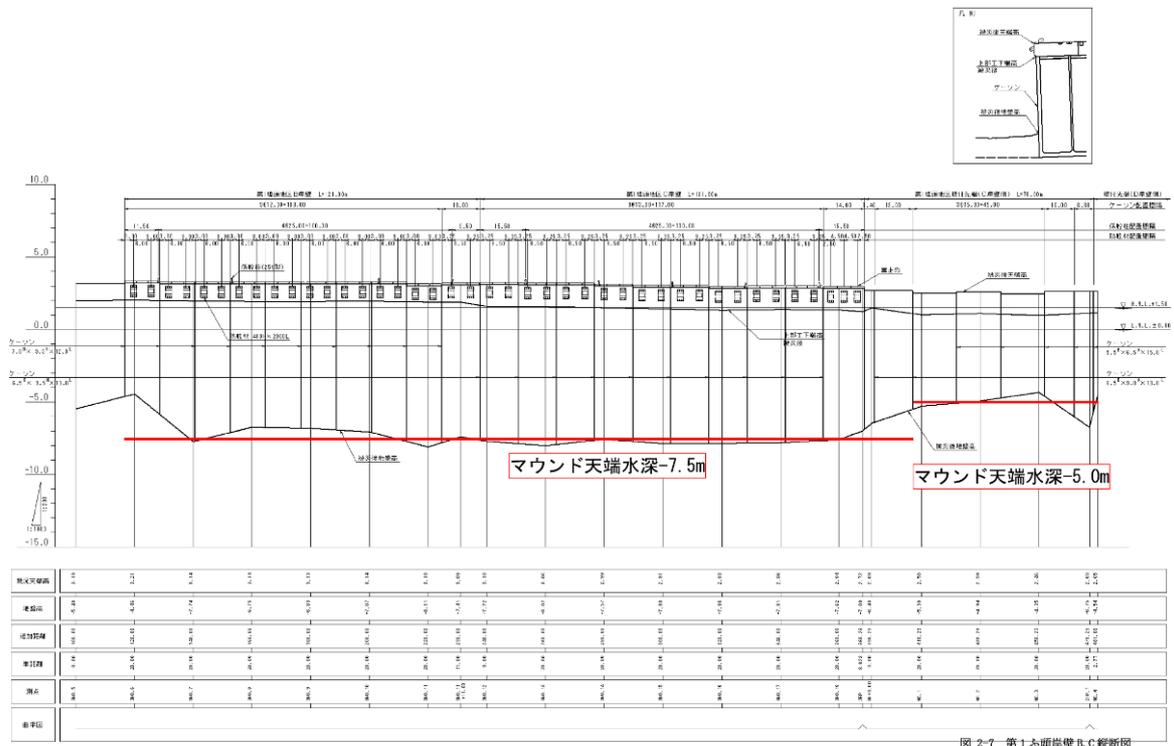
No.3 日立港区_第1ふ頭地区 1-C 岸壁 (-7.5m) の縦断面図 (被災後)
